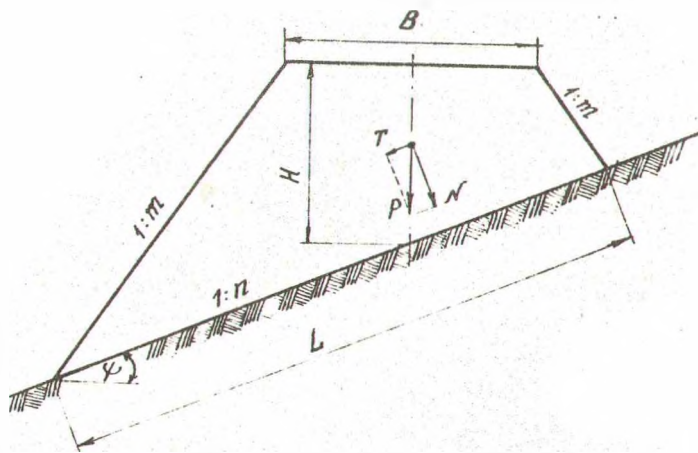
Расчетная схема для насыпи, расположенной на косогоре
